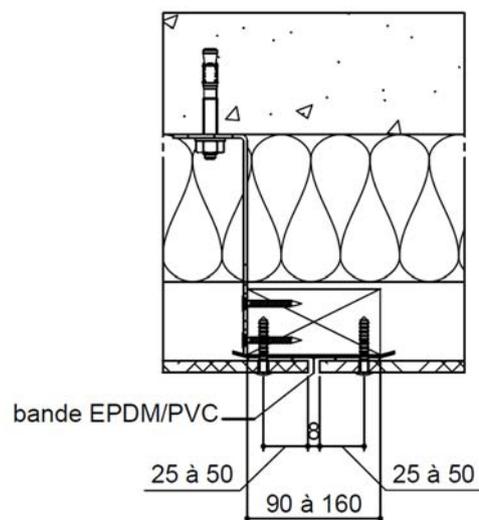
Joint vertical (coupe horizontale) sur ossature bois (cote en mm)
